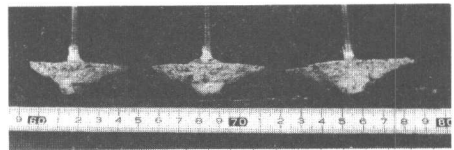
くぎ抜き法による破片 (F B 6 0 C)
